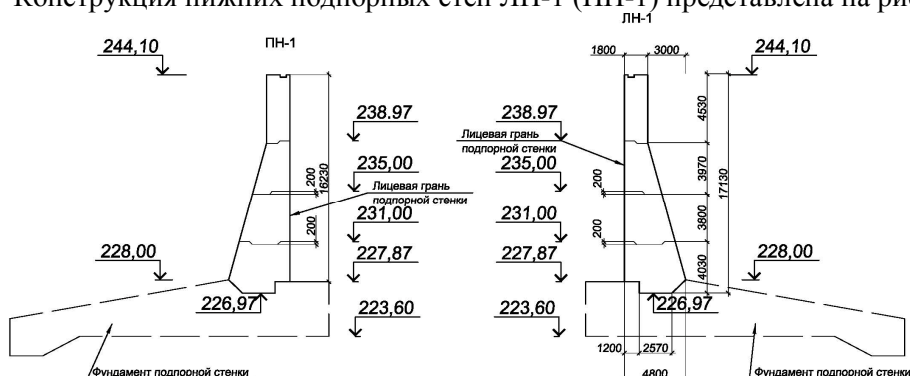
Конструкция нижних подпорных стен ЛН-1 (ПН-1) водоприемника Загорской ГАЭС-2
